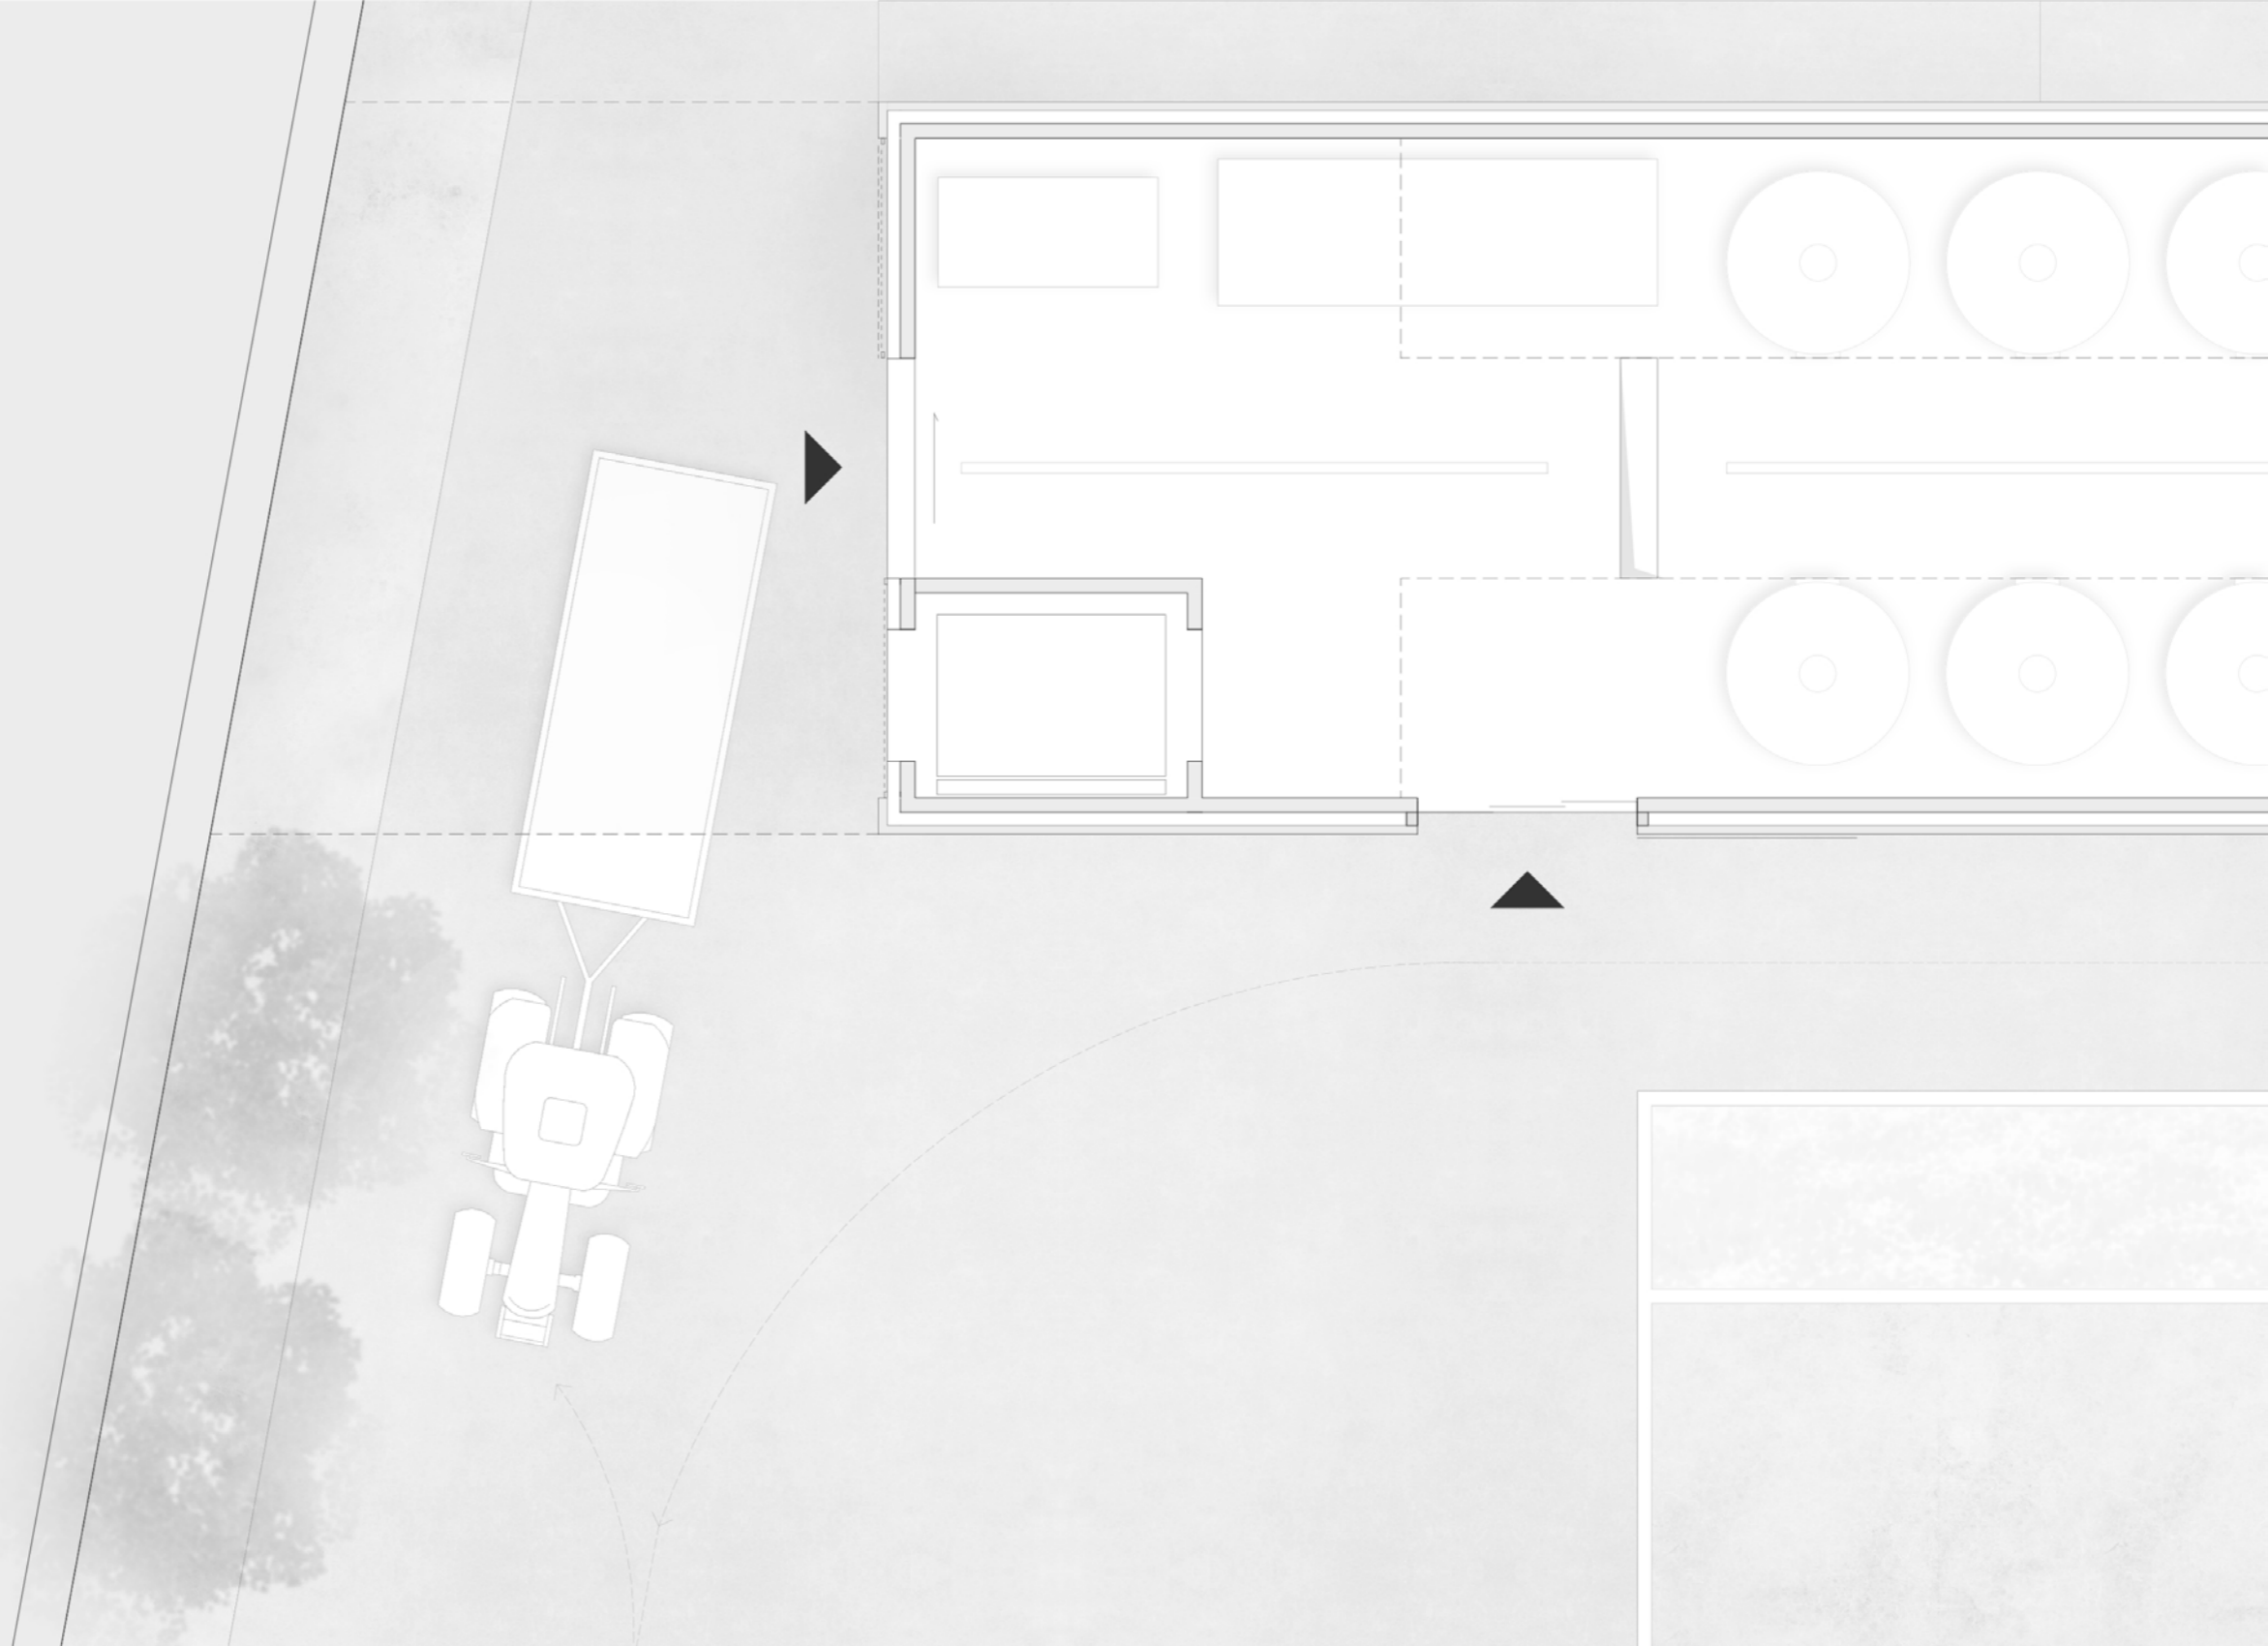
Grundriss Anlieferung - Pressbereich M 1:100
